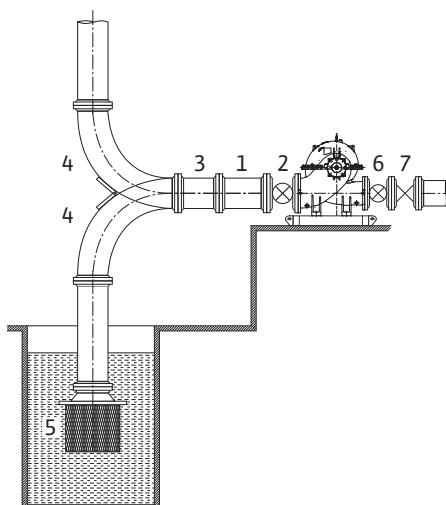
Grundlæggende layout af en pumpeinstalltion
